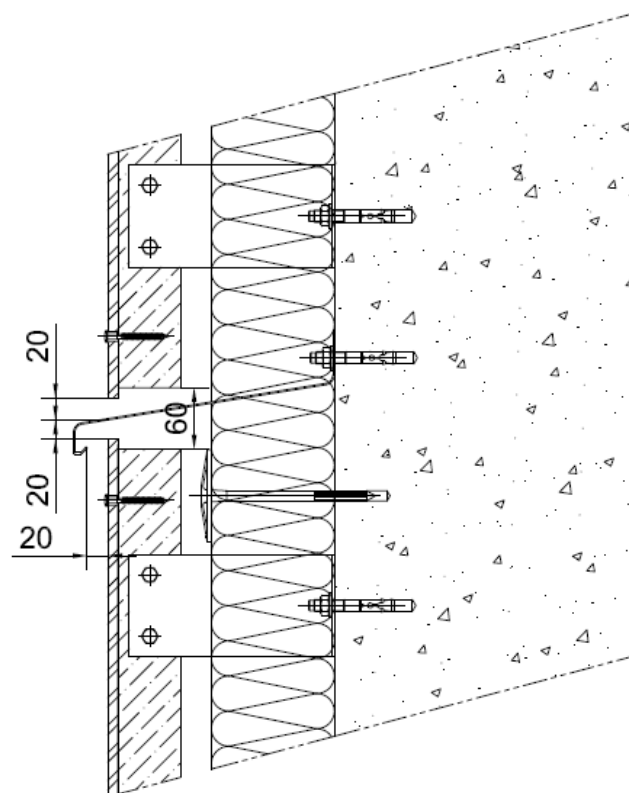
Sección vertical. Fraccionamiento de la cámara de aire.
